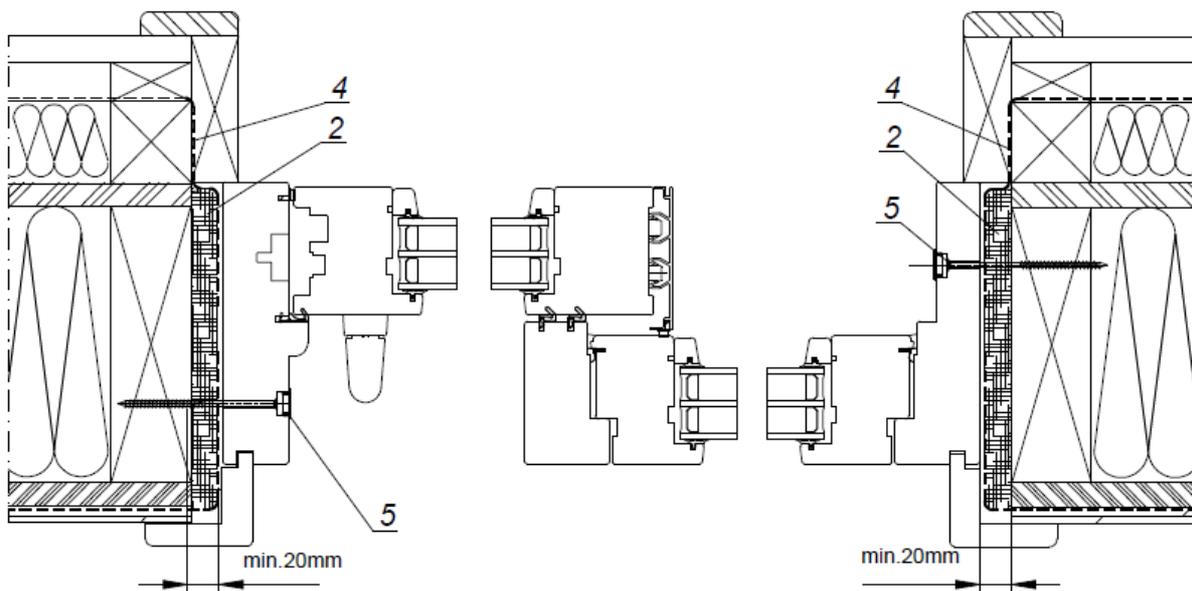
Beispiel für die Montage der ECO-SLIDE in einer modularen Holzwand
